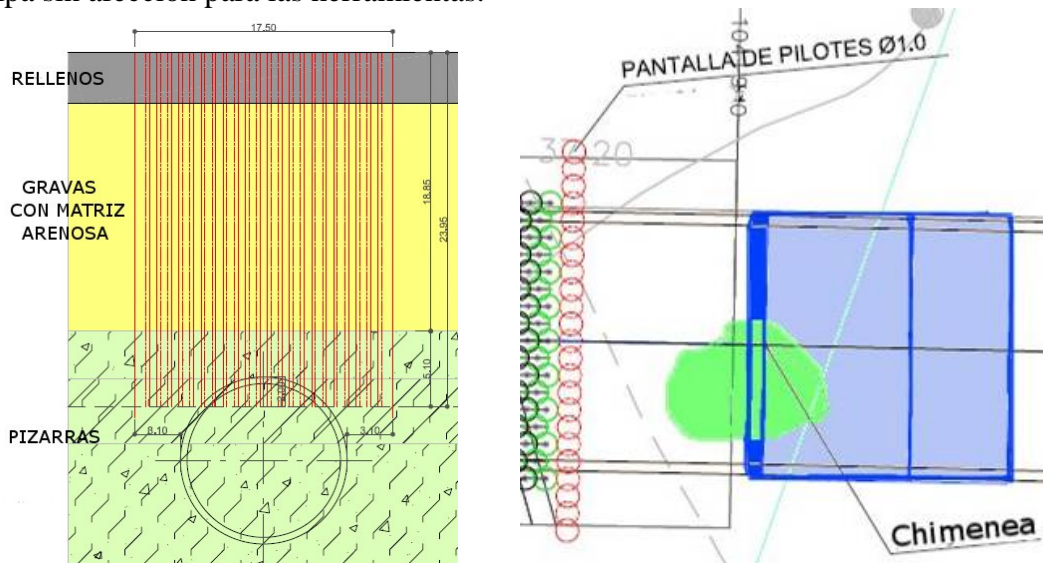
Vista en planta y alzado de la pantalla de pilotes.
